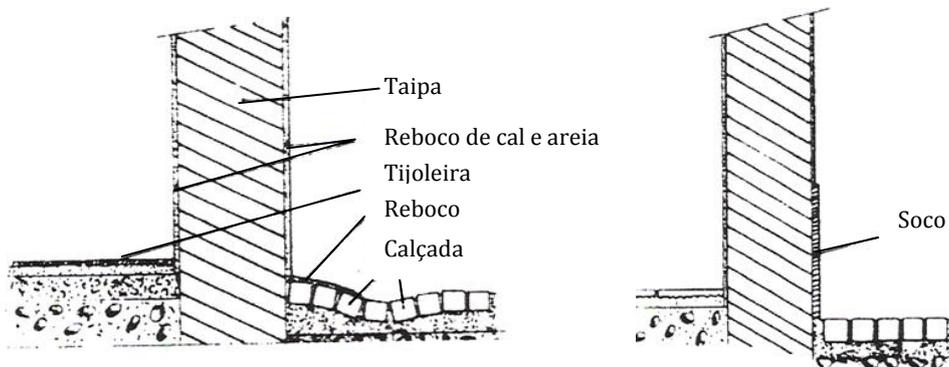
Proteção da parede pelo exterior para evitar infiltrações [11]
